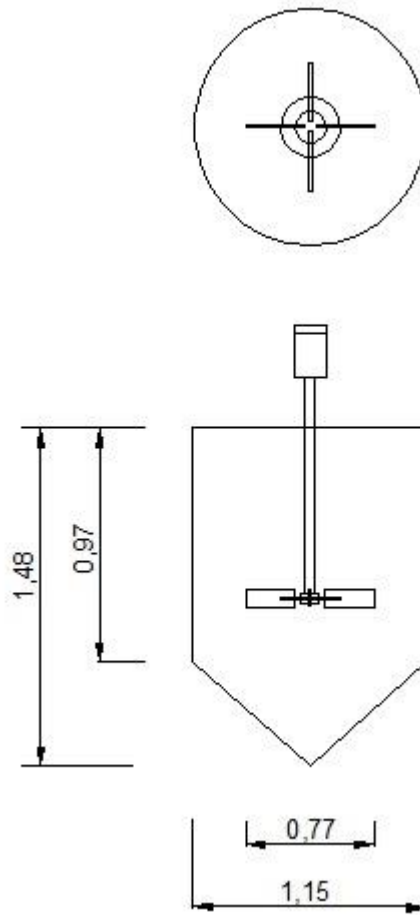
Corte e planta do tanque de mistura rápida (medidas em metros)
